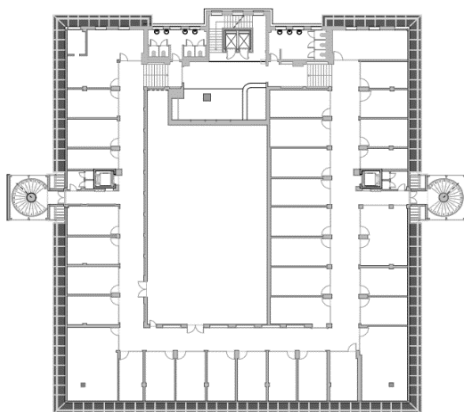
Planta Piso 2, Centro comercial Girasolum.
